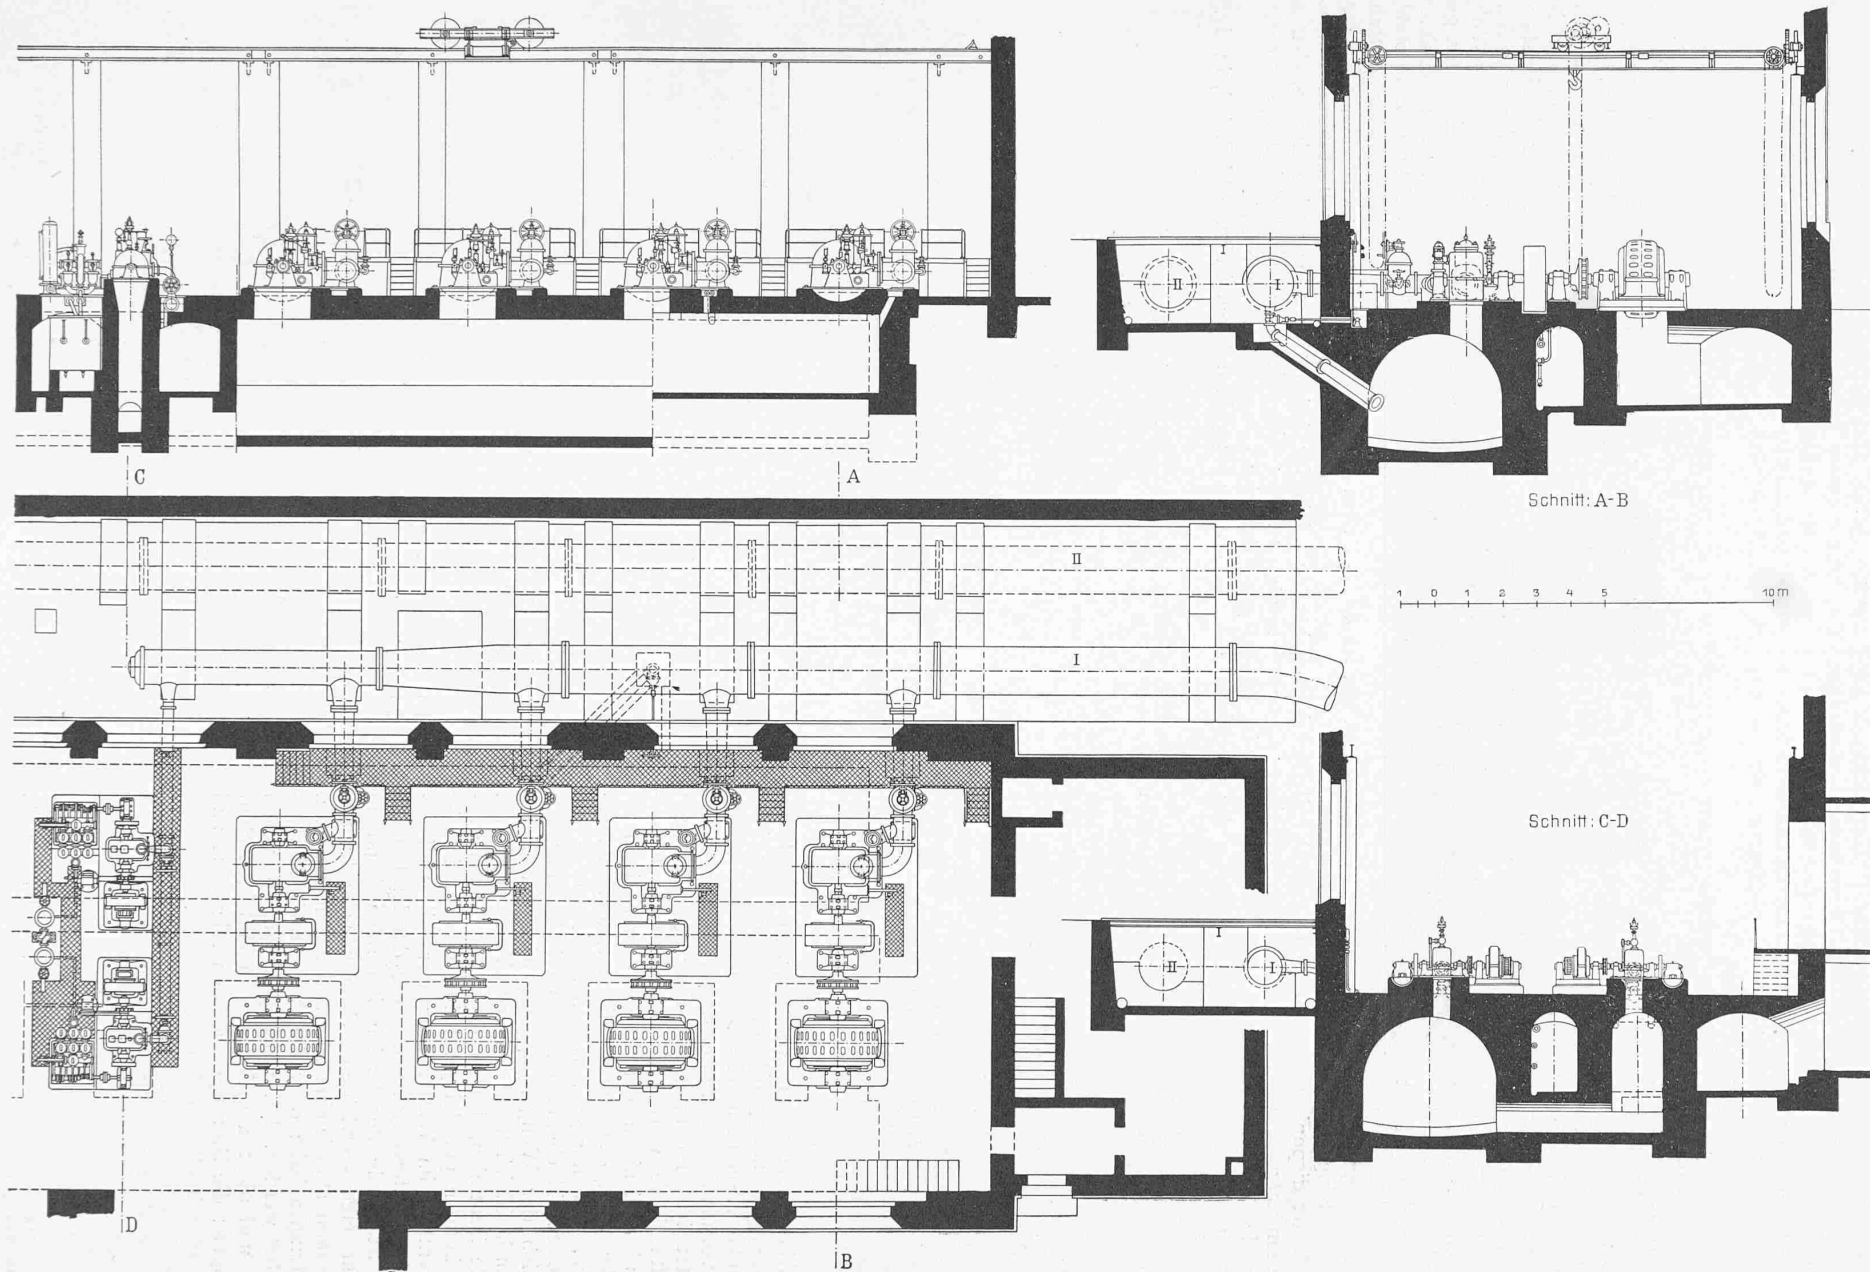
Das Elektrizitätswerk Burglauen. — Grundriss und Schnitte der z. Zt. ausgebauten östlichen Hälfte des Maschinenlautes. — Masstab 1 : 200.
